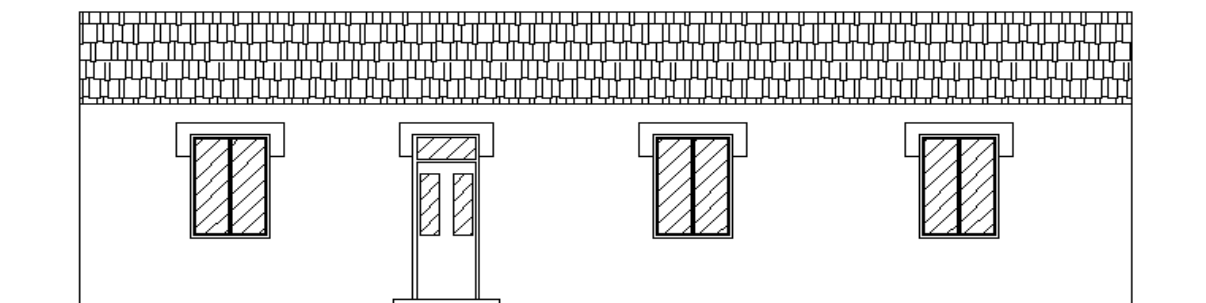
La façade type des maisons de la cité BON ACCUEIL
